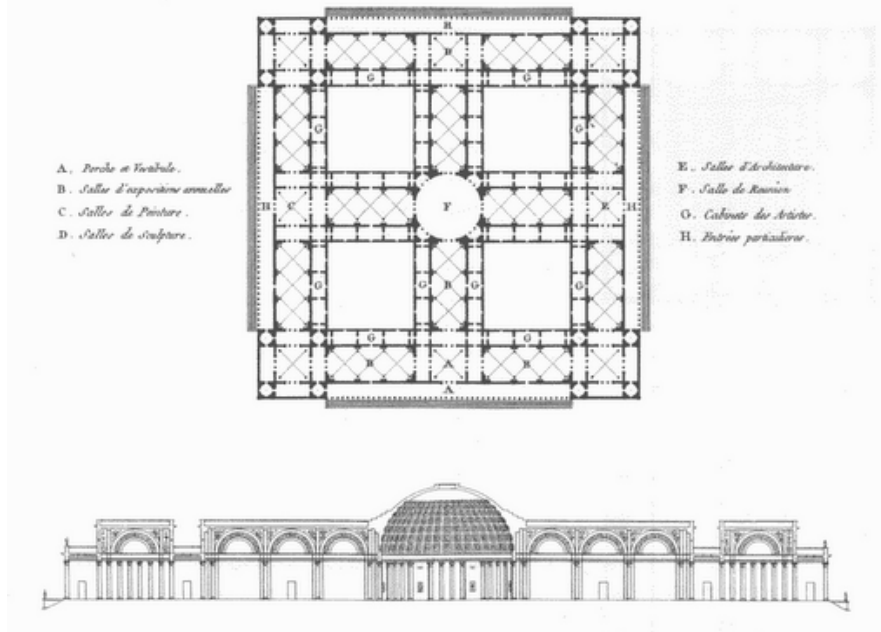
Durand, proyecto para un museo, planta y alzado, 1802 – 1809.
